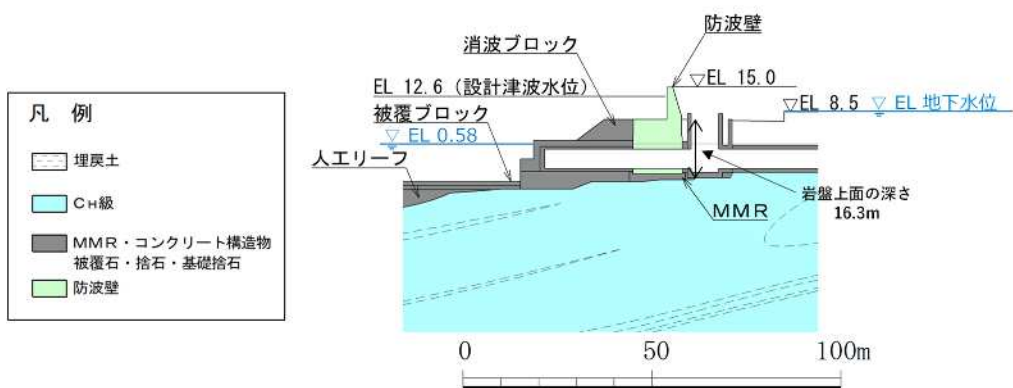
防波壁（波返重力擁壁）の横断面図
